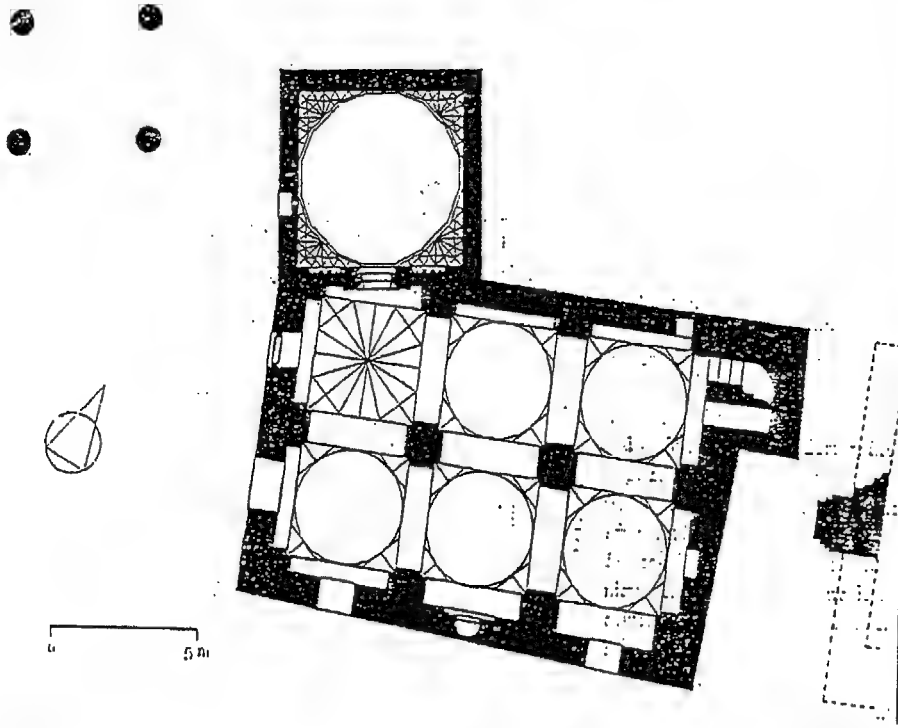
مسقط أفقى لسبيل وحوض محمد بك أبى الذهب الملحق بجامعة بالطابق الأرضى.
